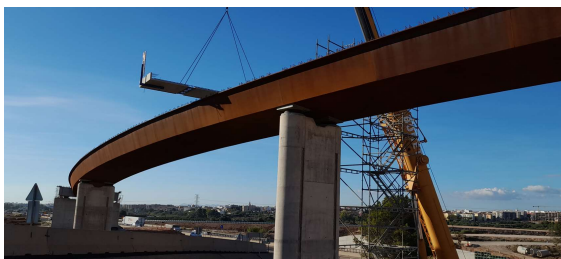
Colocación de prelosas colaborantes de ancho completo.
